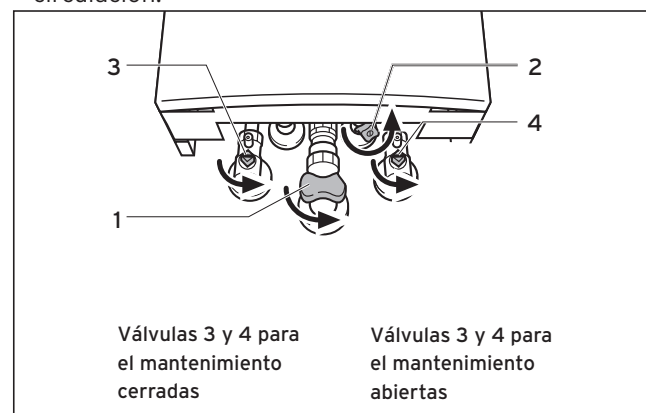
Abrir los dispositivos de cierre (VMW 356)
